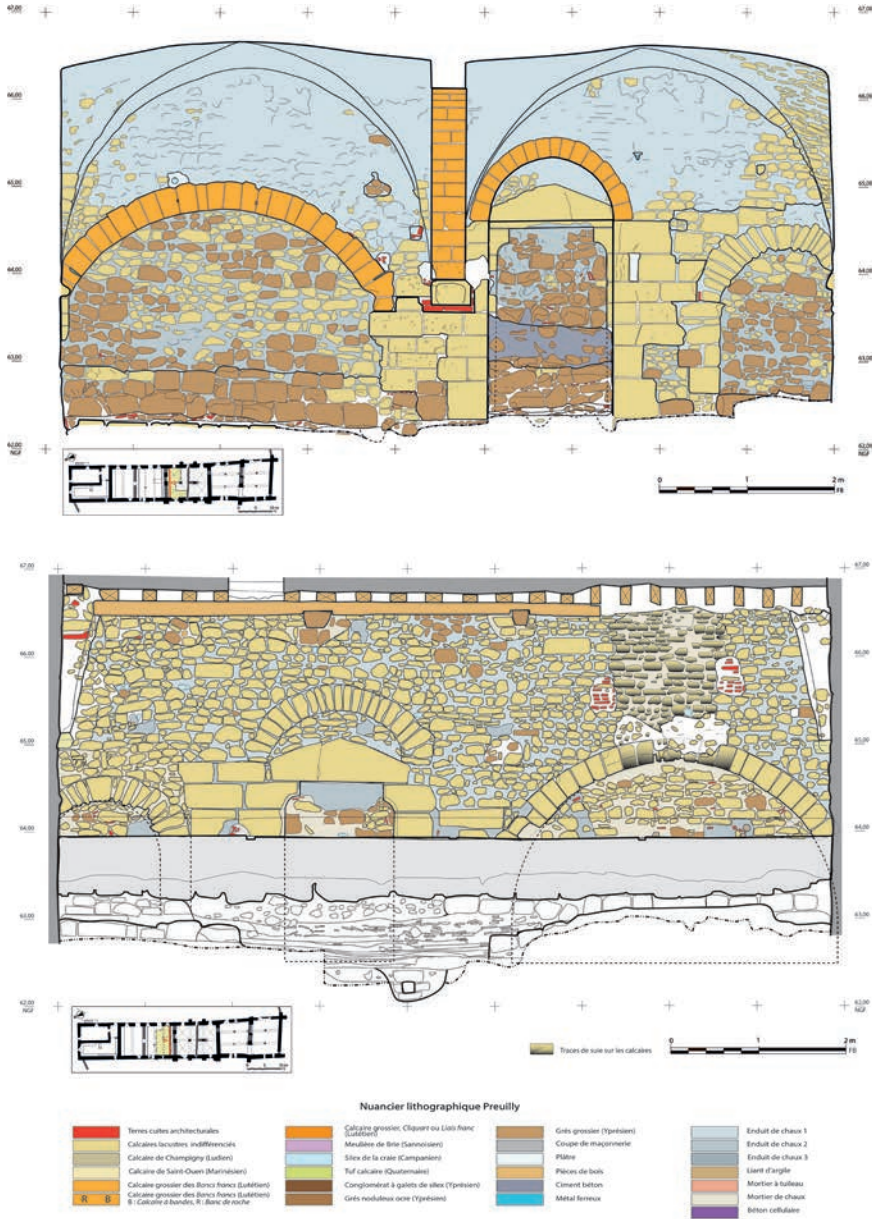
En haut : Relevé pierre à pierre du mur nord de la salle 4 de la Grange des Beauvais avec l'indication de la nature des pierres.
